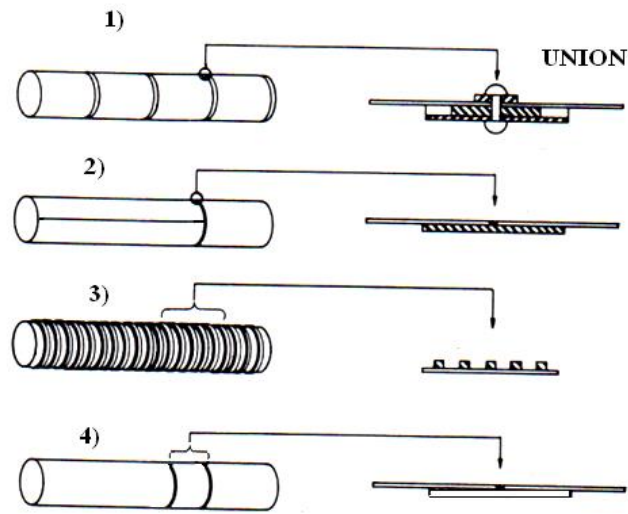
Imagen de los tipos de tuberías. Modificación al propuesto por López Mendiola¹⁰¹ 1) remachado 2) soldado 3) blindado 4) concreto.
